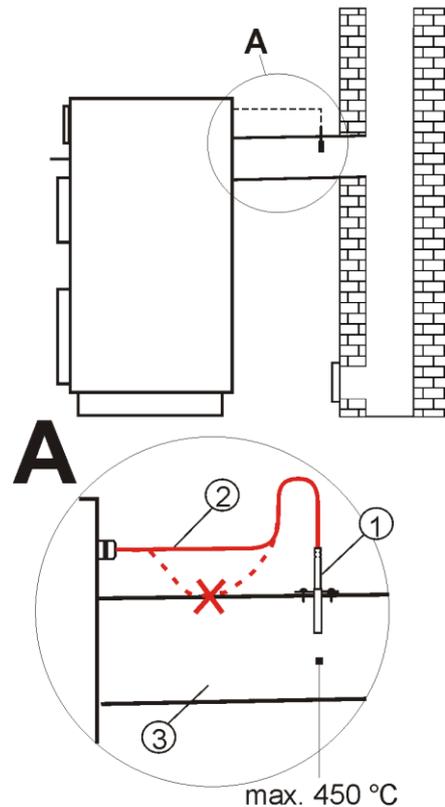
Anschluss des Abgassensors: 1 – Abgassensor Typ CT2S, 2 – Sensorkabel, 3 – Steigrohr.
